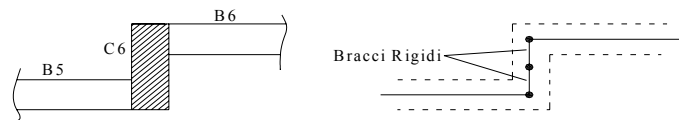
Particolare modellazione del nodo tra le travi B5 e B6 ed il pilastro C6
